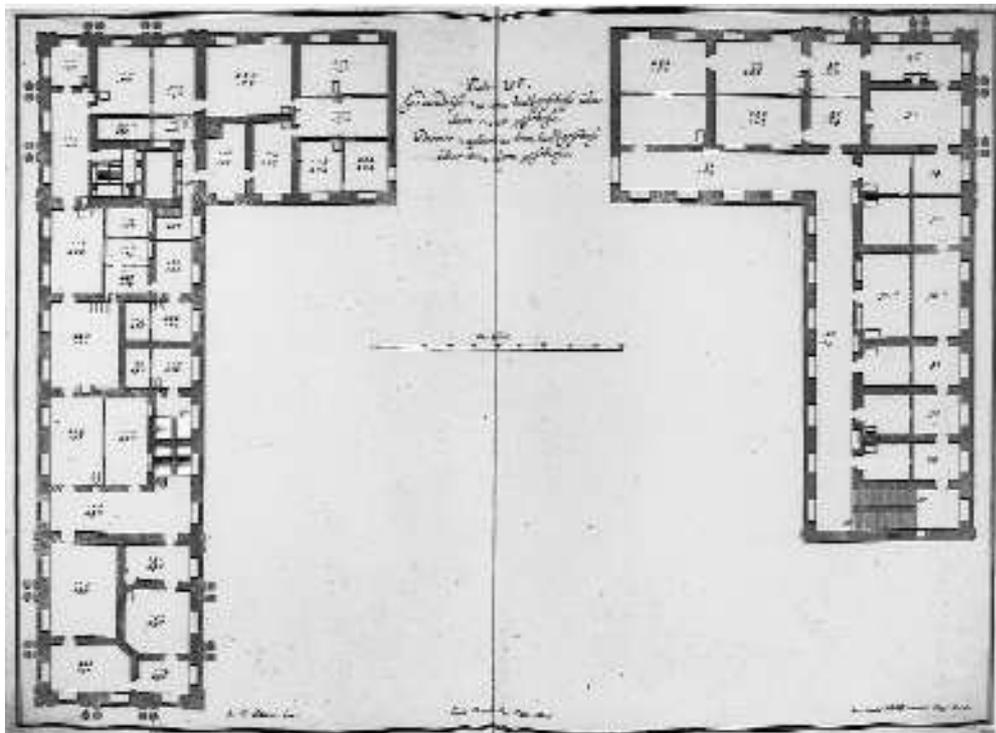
Sturm, Fürstlicher Palast, Teilgrundrisse des Mezzanin, 1714
